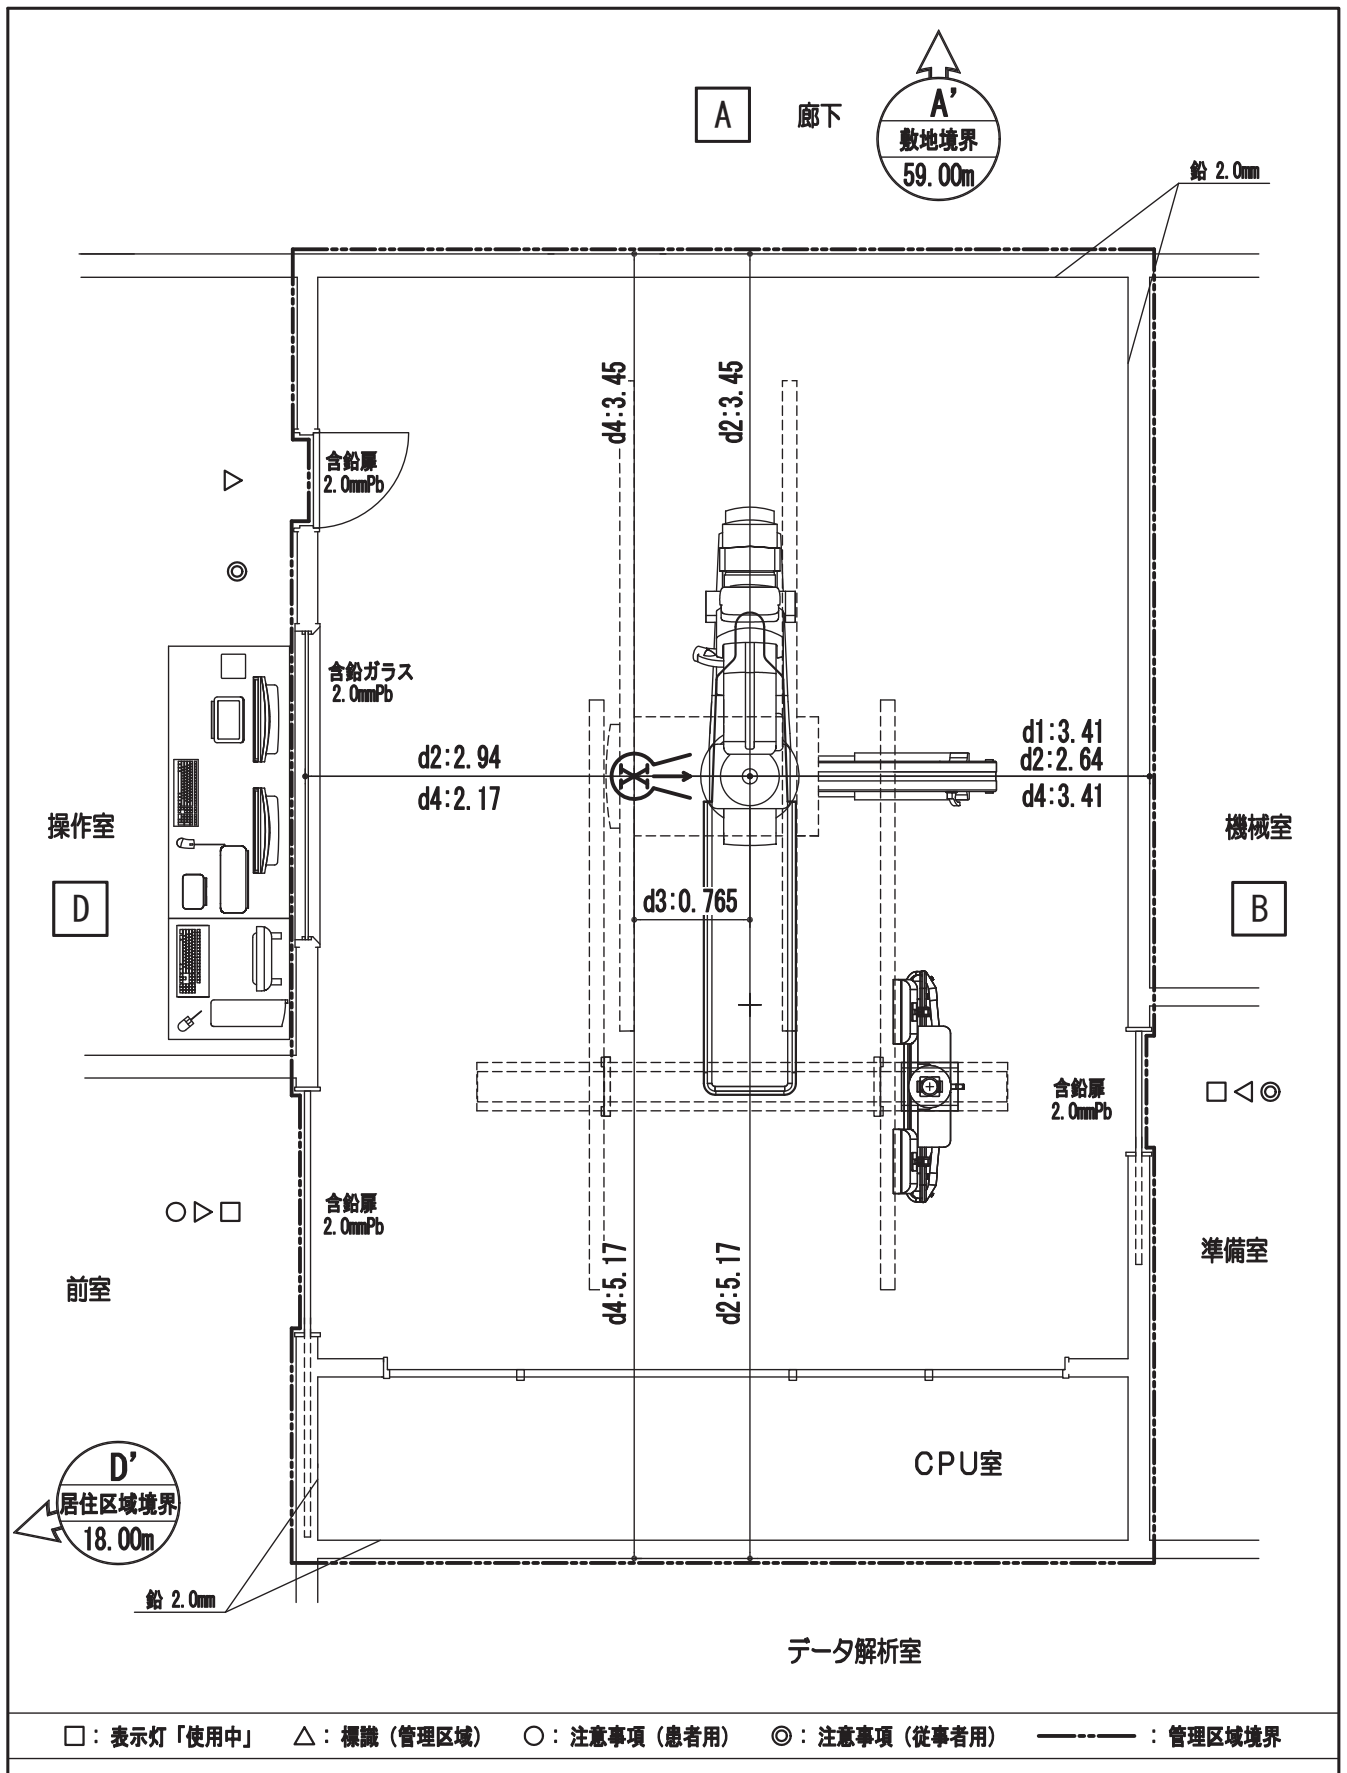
循環器用X線診断装置 天井吊管球 透視・撮影 平面図
